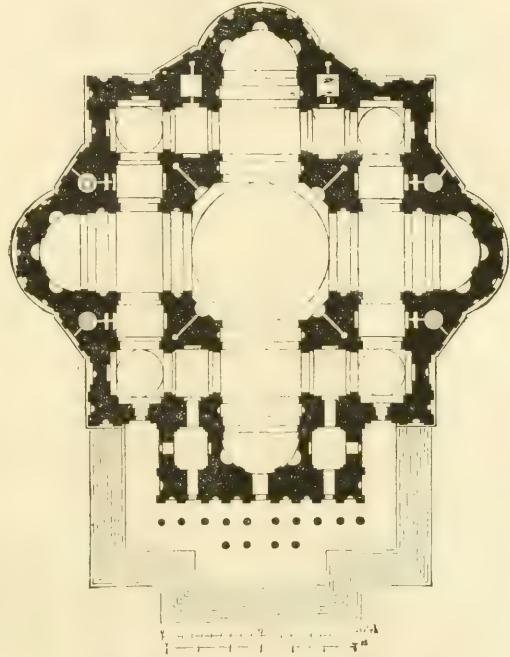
Michelangelo's Grundriss für St. Peter.
